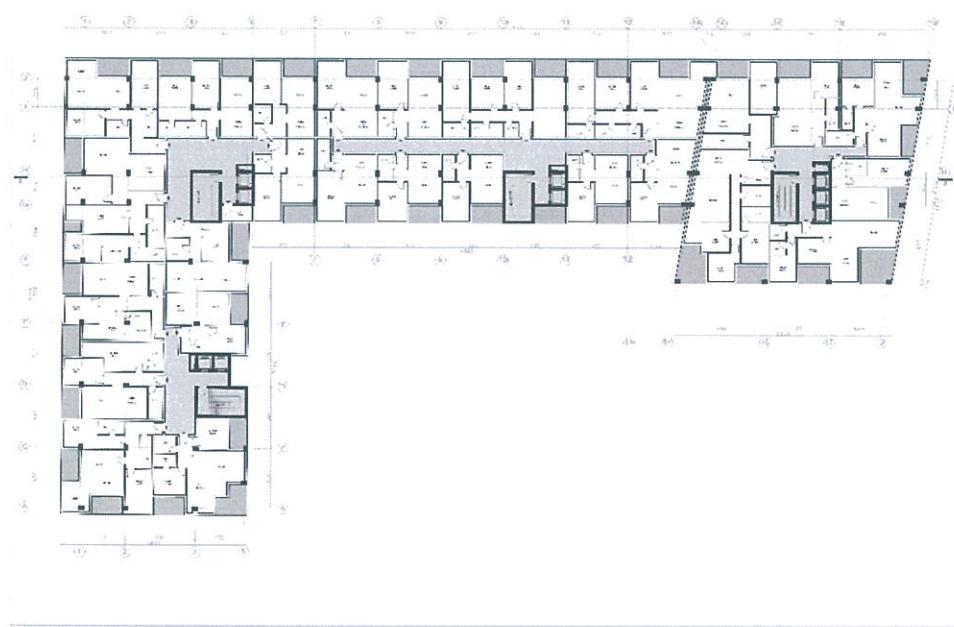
Planimetria në Kuotën +5.25 deri +15.75
